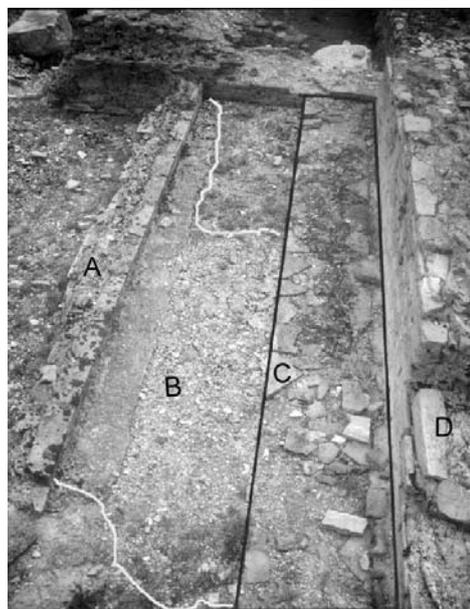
Struttura muraria situata sul lato occidentale del vestibolo nord del ponderarium. A. Muro verso il vestibolo; B. Pavimento in cementizio; C. Muro interno; D. Parete di fondo (F. Cubellotti).
